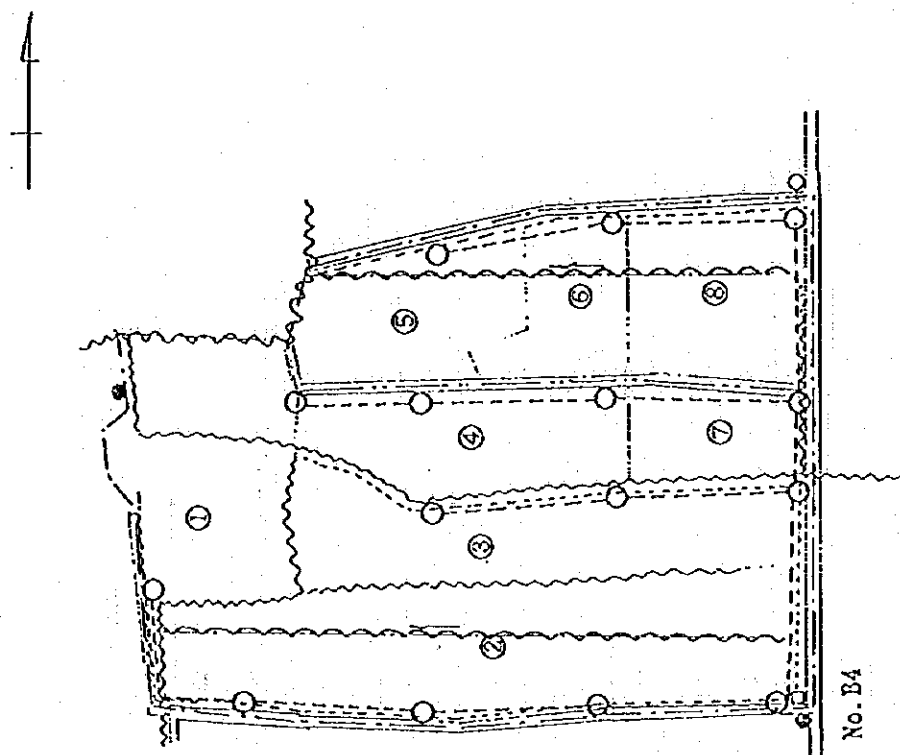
Plan horizontal du projet des installations terminales (Atilet)
